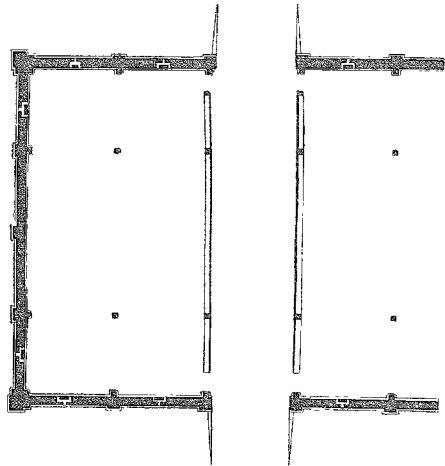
Grundriß einer gemauerten Scheune mit Quertenne.
